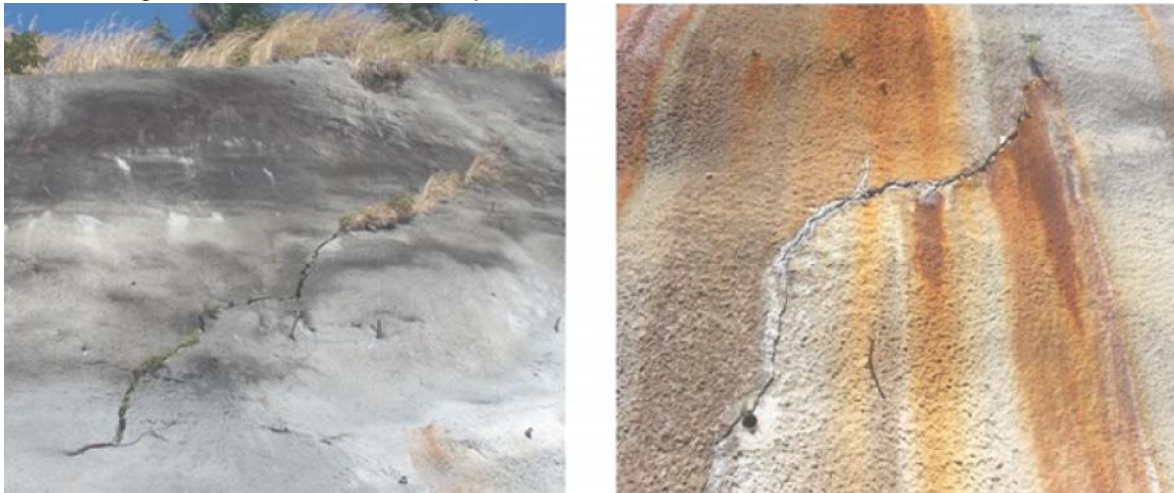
Talud lado derecho, detalle de grietas en el concreto lanzado. Dimensiones 1 - 3 m.
